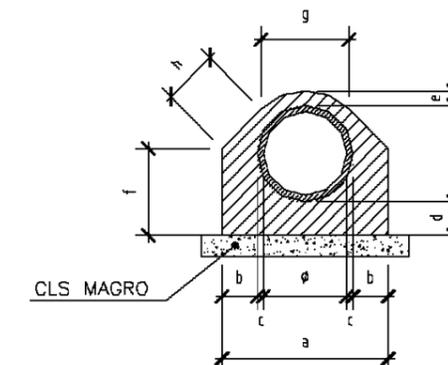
Tombino tubolare (Sezione longitudinale)
